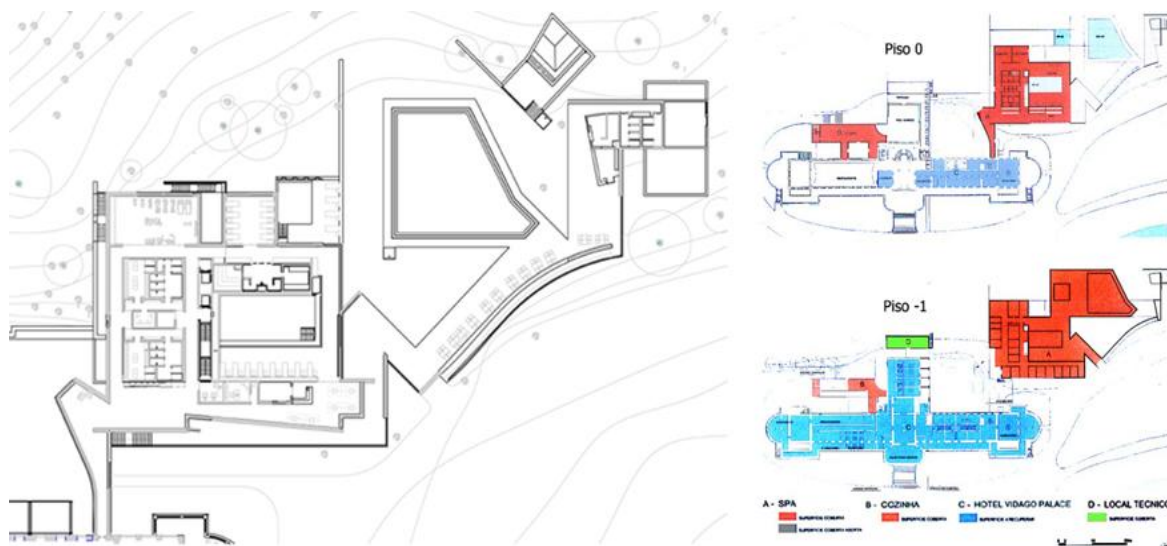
Planta piso 0 do Spa e esquema de ligação com o Hotel
